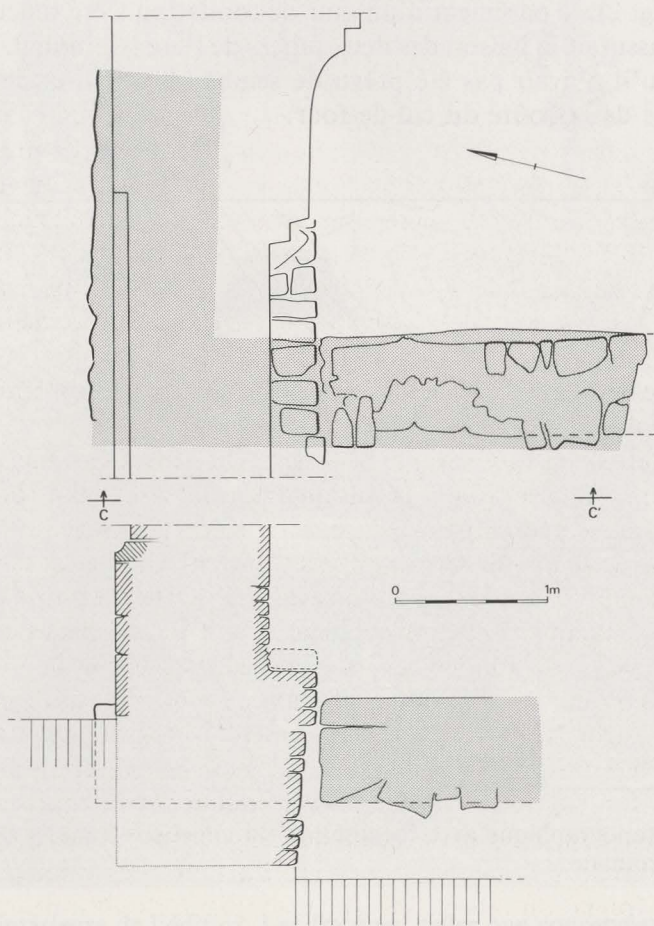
D'après A. BARENTSEN: plan et coupe du mur ancien (trame pointillée) localisé sous la façade septentrionale du chœur roman.
